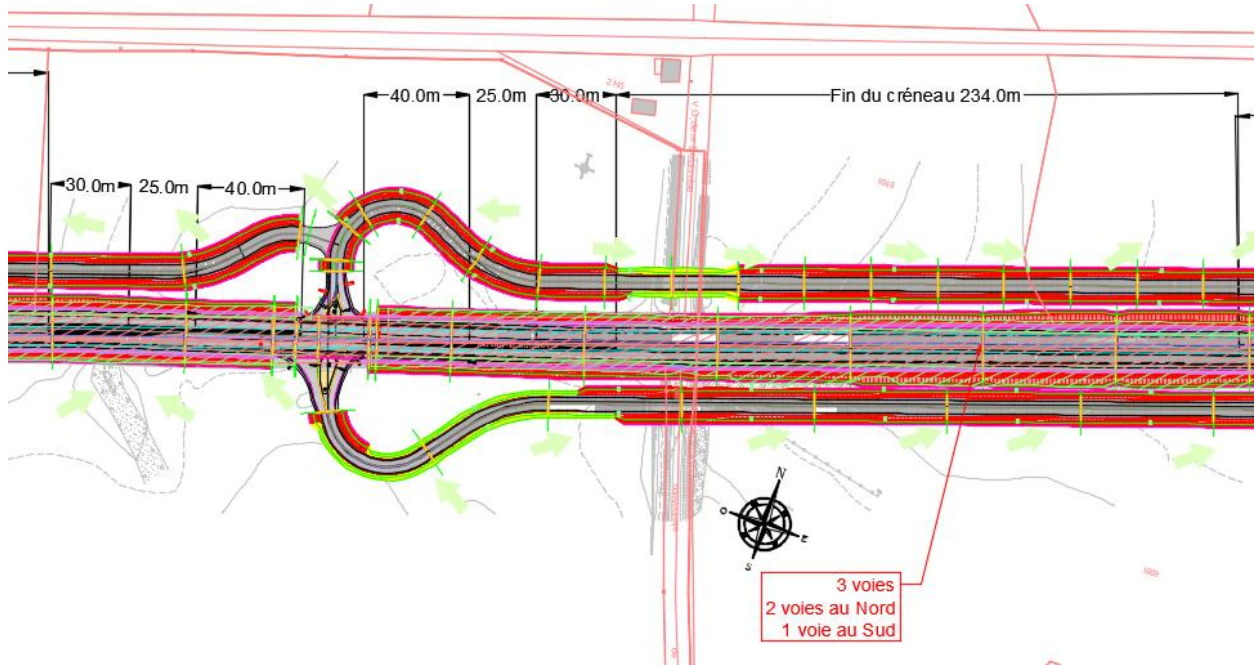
Plan du carrefour de Saint Eugène - Section 2
